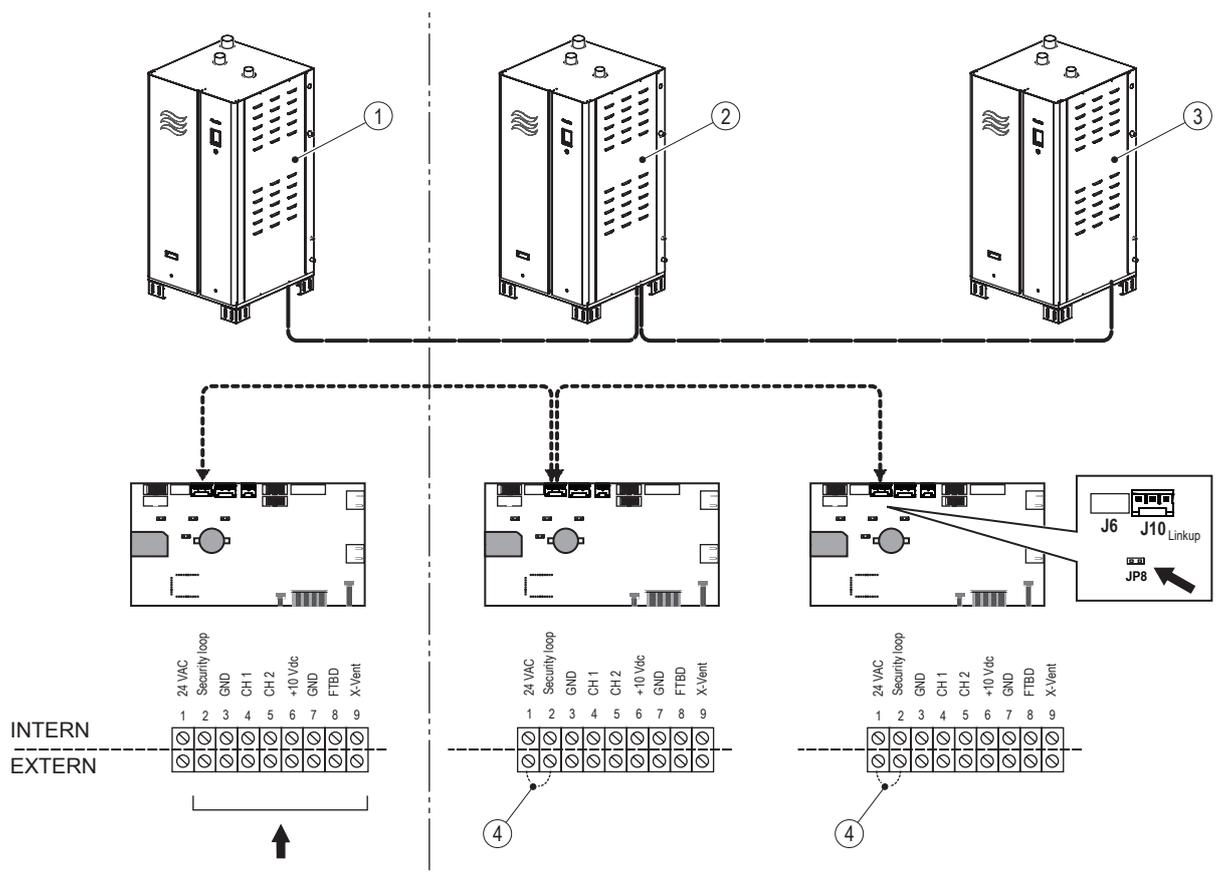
Linkup-Verbindung mehrerer Befeuchter
